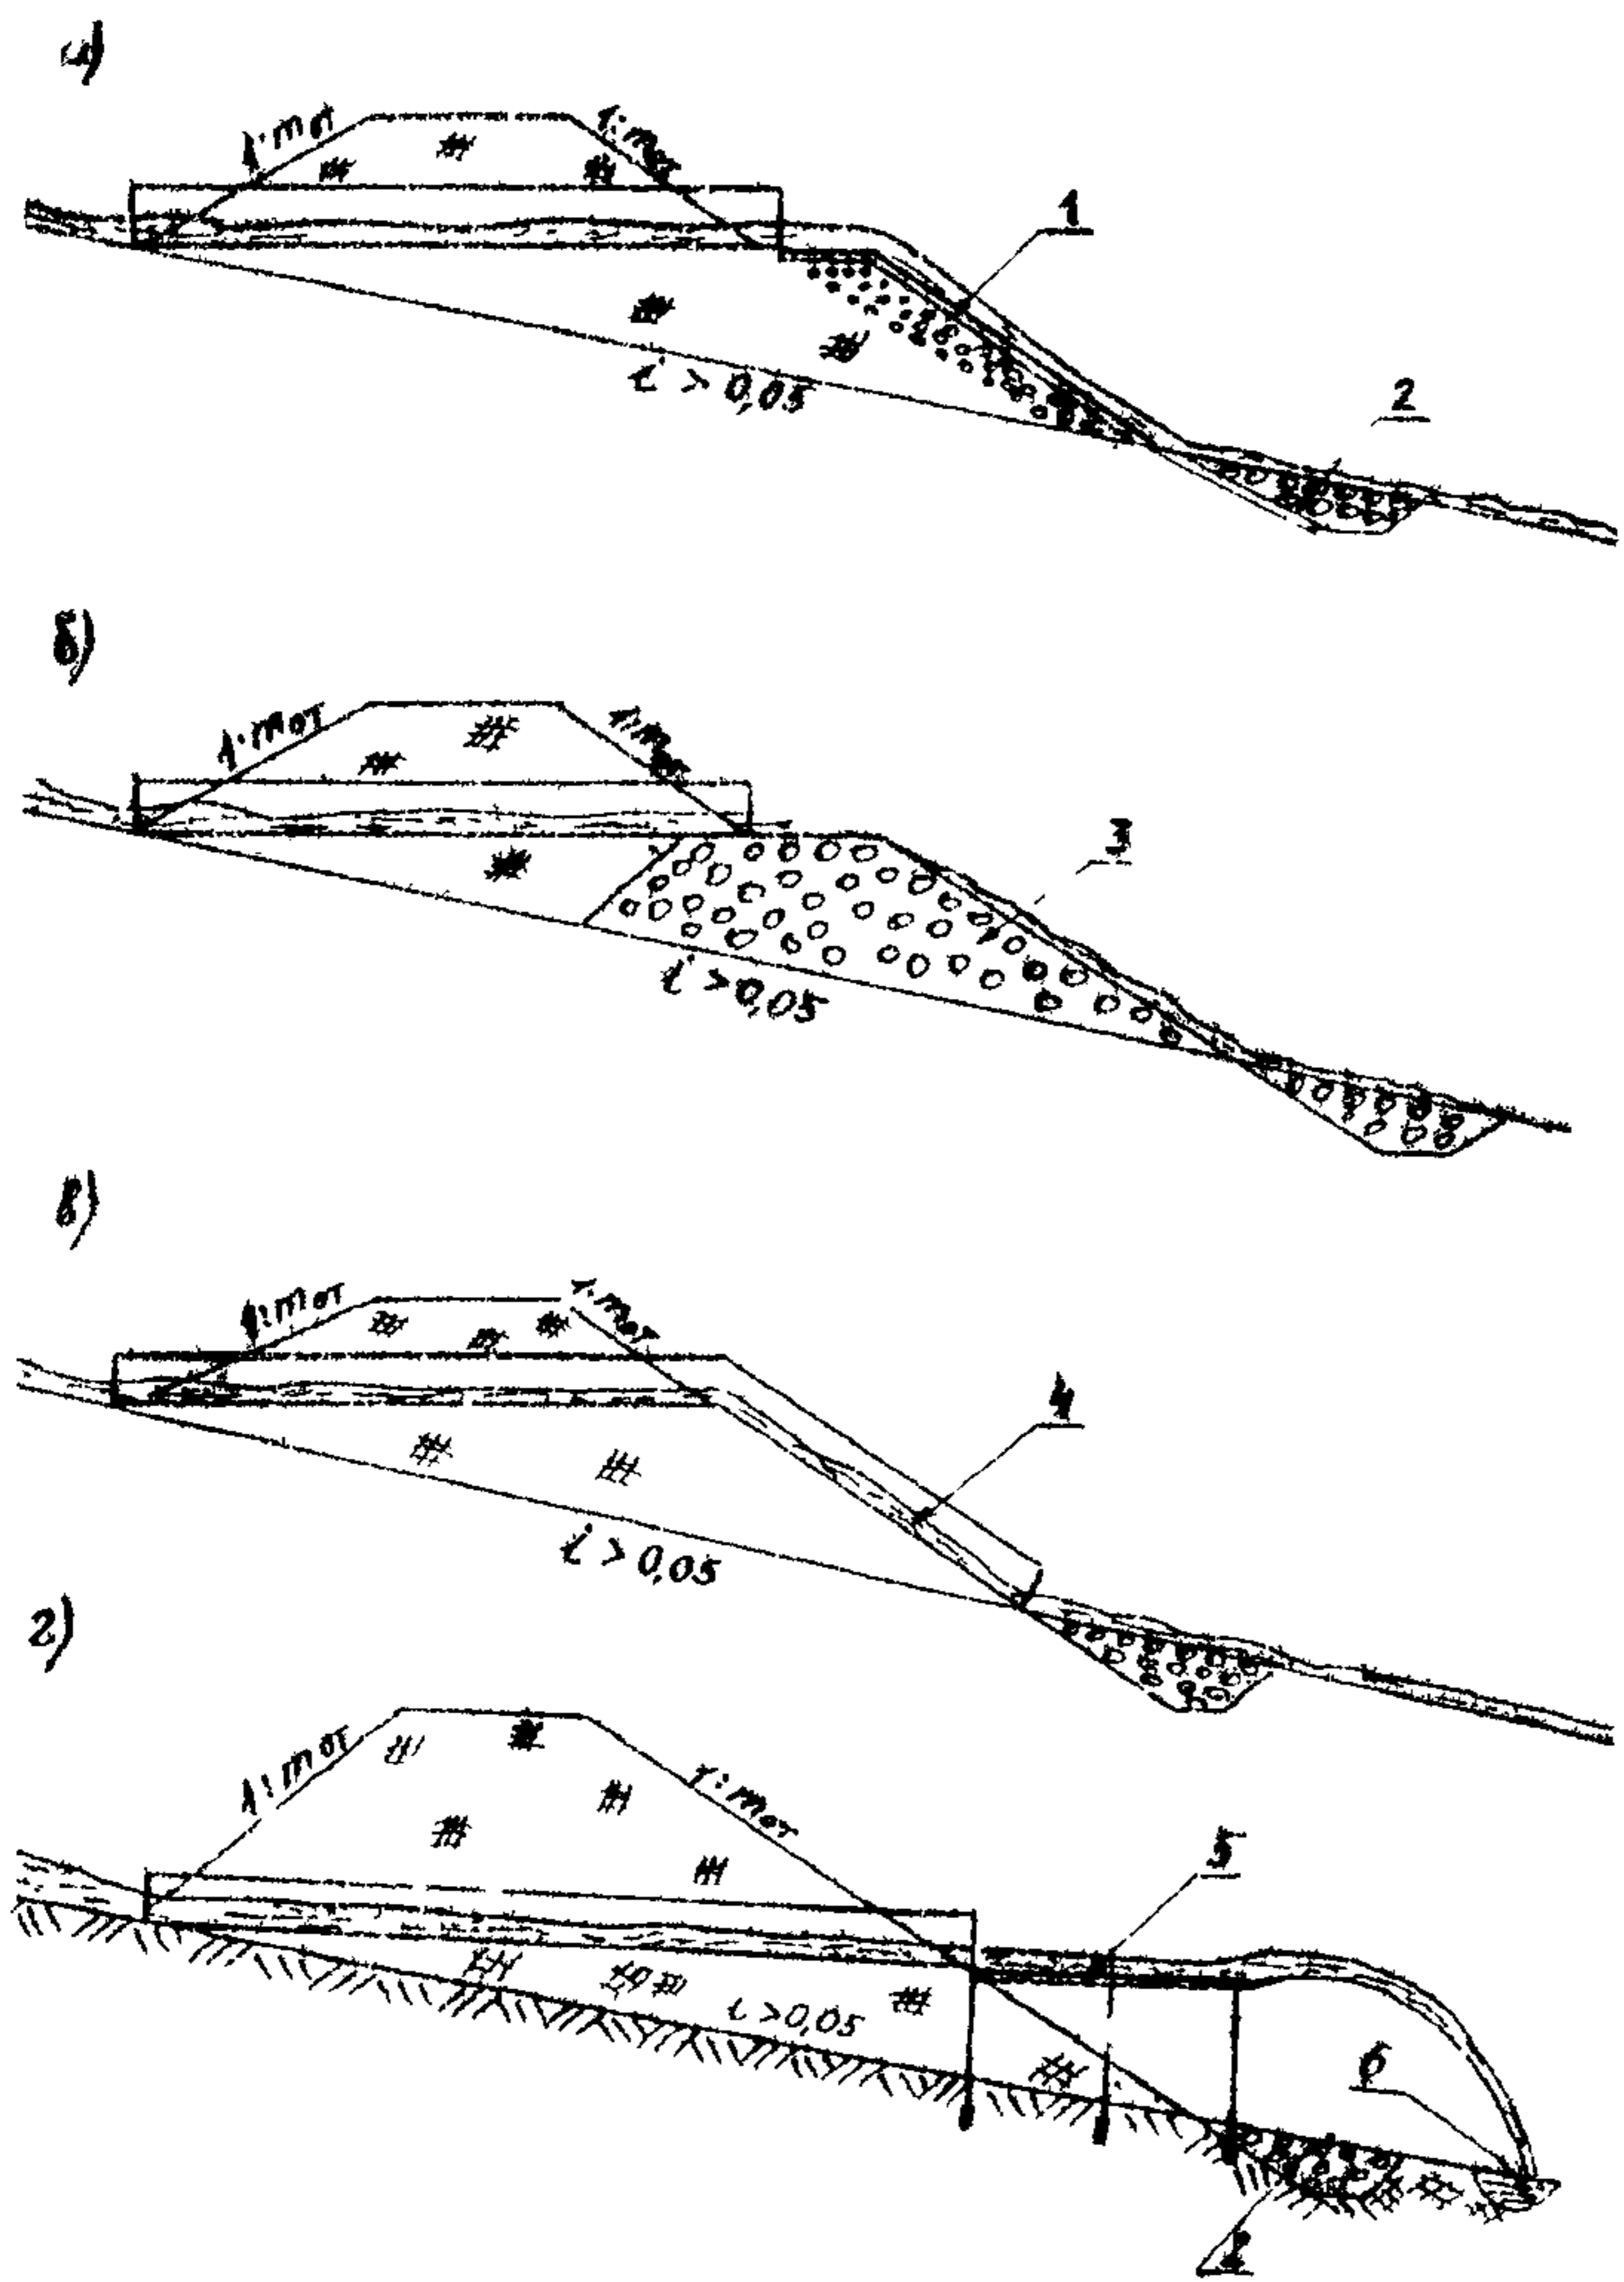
Типы укладки гофрированных косогорных труб на насыпной грунт в теле насыпи:
